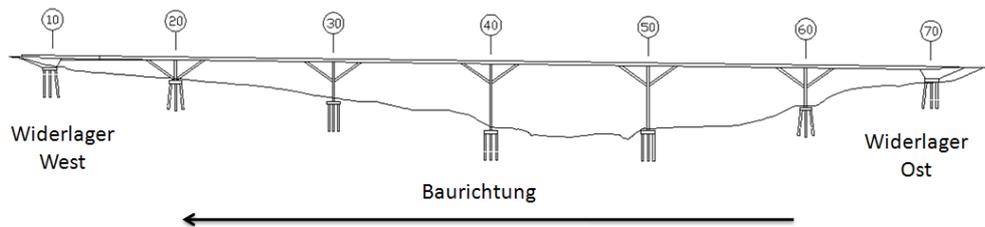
Andelsbachtalbrücke mit dem Brückenklappverfahren
